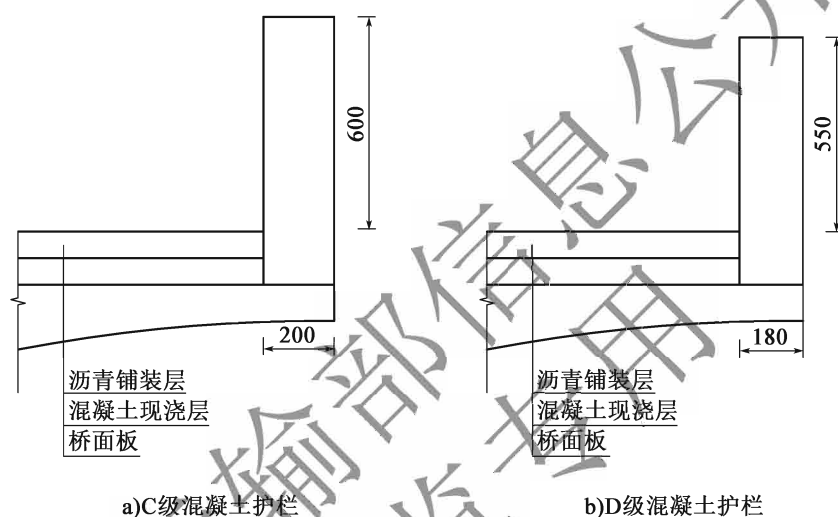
桥梁混凝土护栏横断面布置(尺寸单位: mm)
